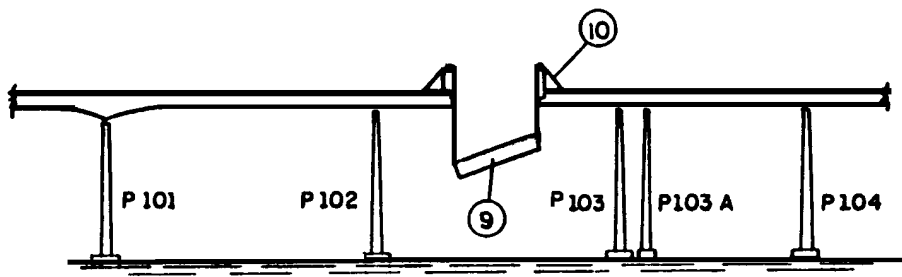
Seqüência de montagem dos elementos metálicos pré-fabricados.
